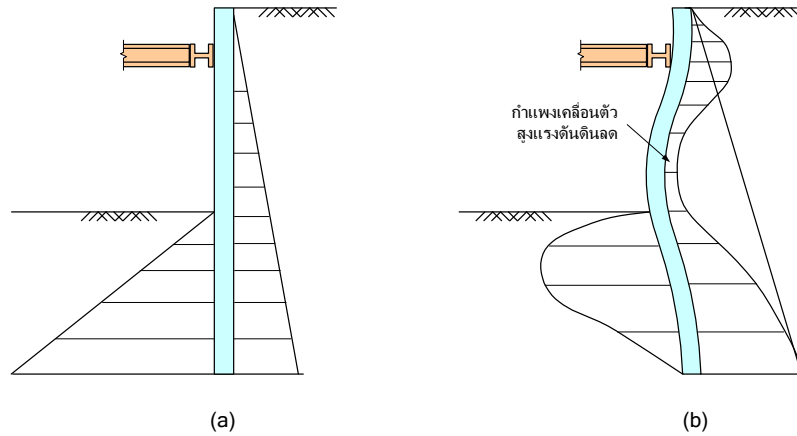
เปรียบเทียบสติฟเนสของกำแพงชนิด Rigid wall และ Flexible wall
